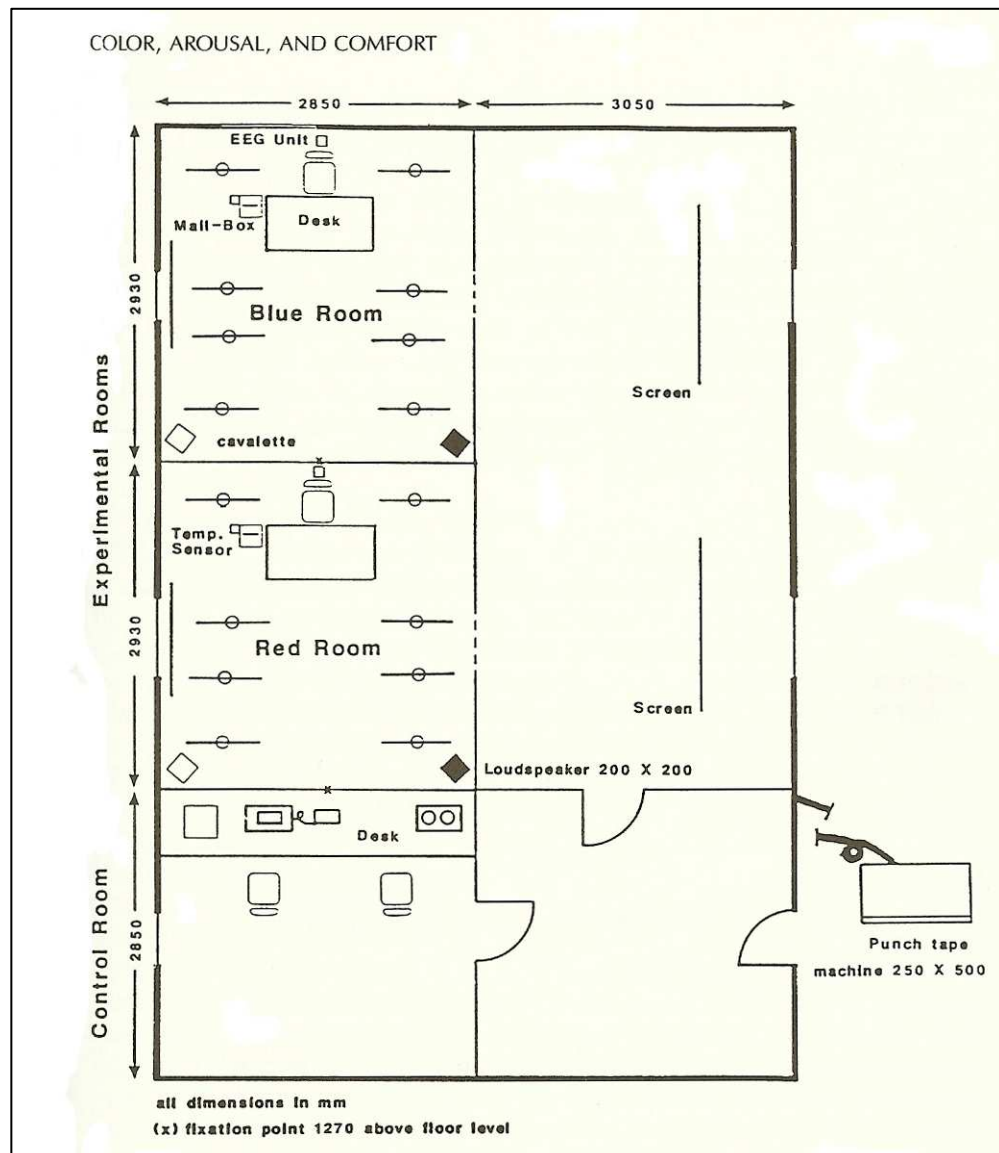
Plan of the experimental rooms and control room from the second study of Lund (after Mikellides, 1989). Grundriss vom Versuchsraum und dem Kontrollraum in Lund
